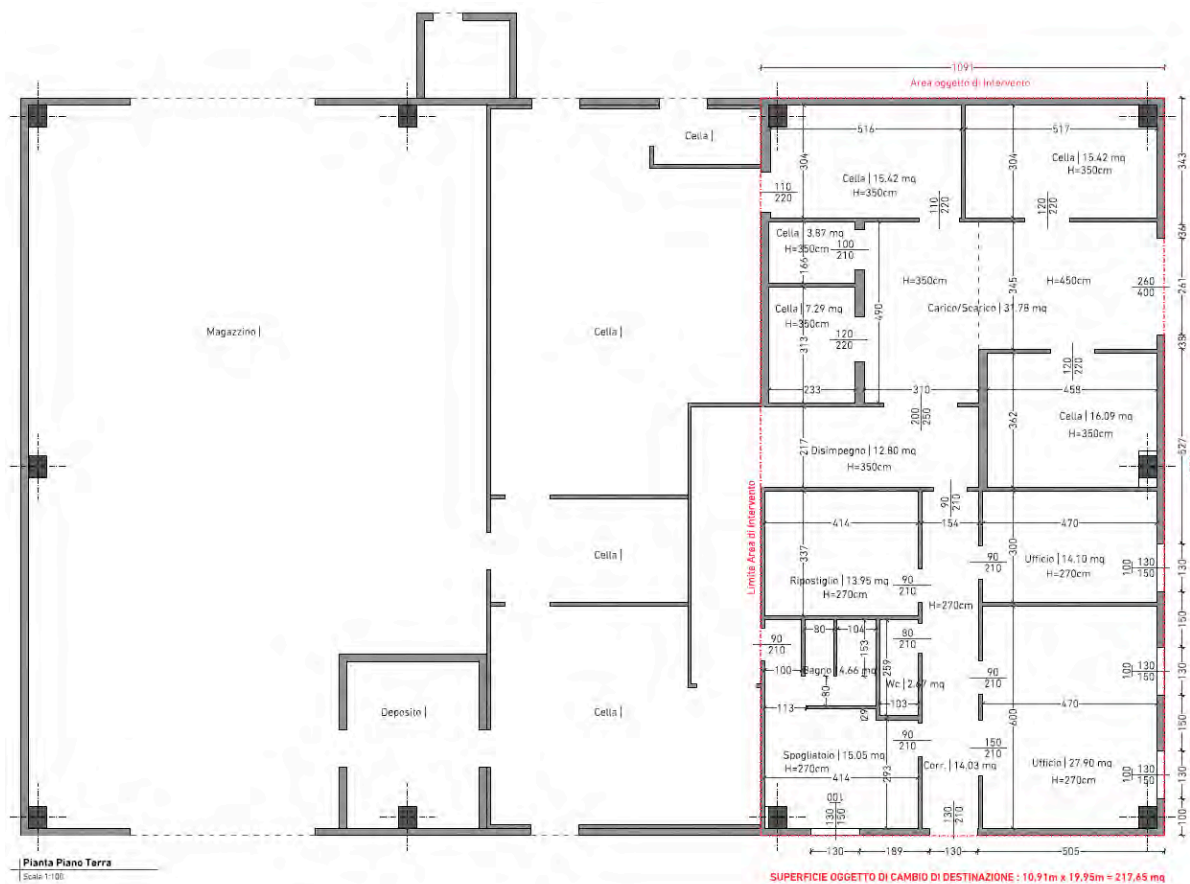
Pianta di progetto - estratto della Tav. 7
